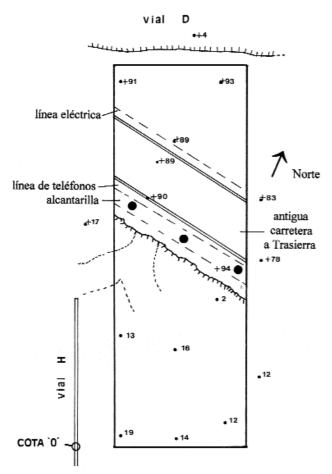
Plano de planta inicial y Cota "0" (1: 400)
